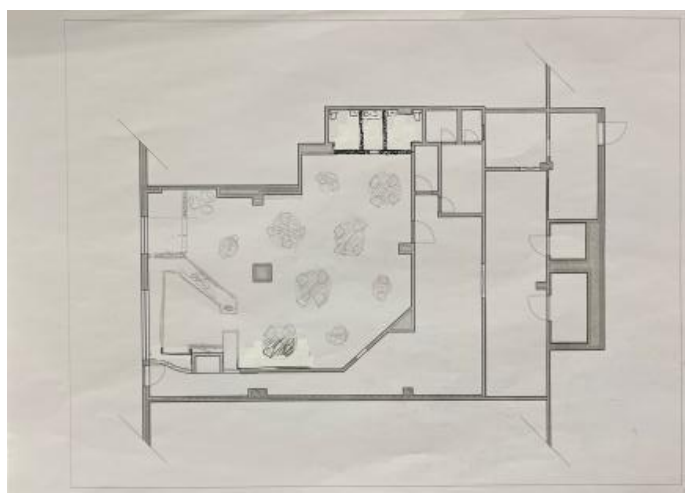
Planta de estudo 6. Fonte: Autora, 2025
